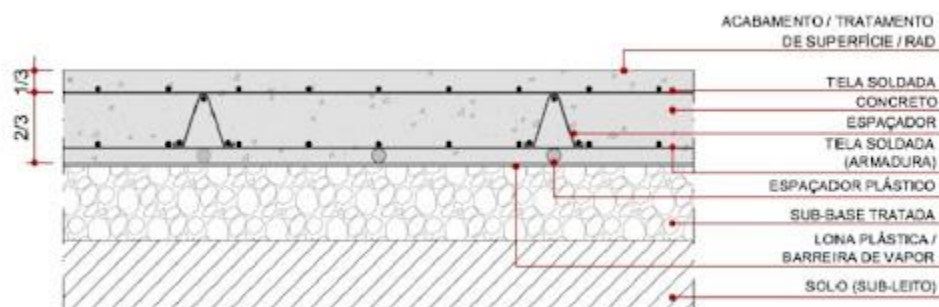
Estrutura do pavimento estruturalmente armado [Carvalho, (2009)]
